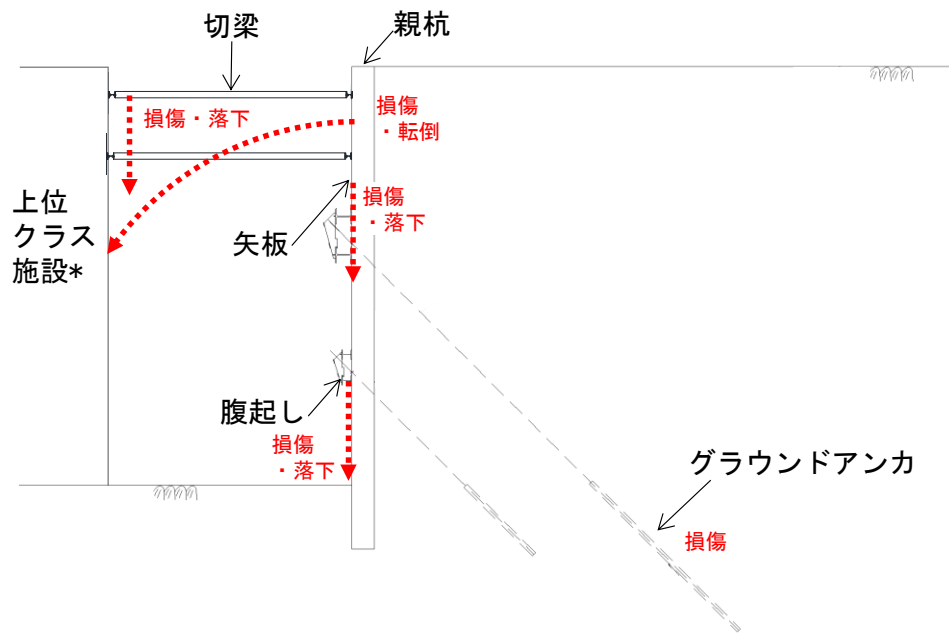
土留め工（親杭） 概略断面図（⑤-⑤'断面）
